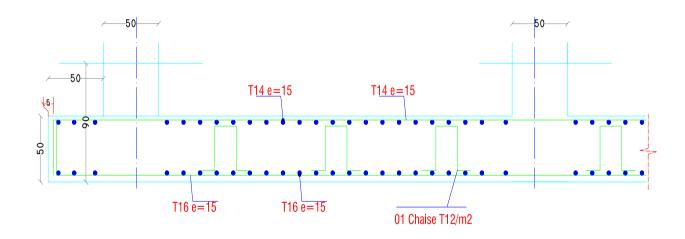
Exemple de coupe de ferraillage de la dalle de radier général
